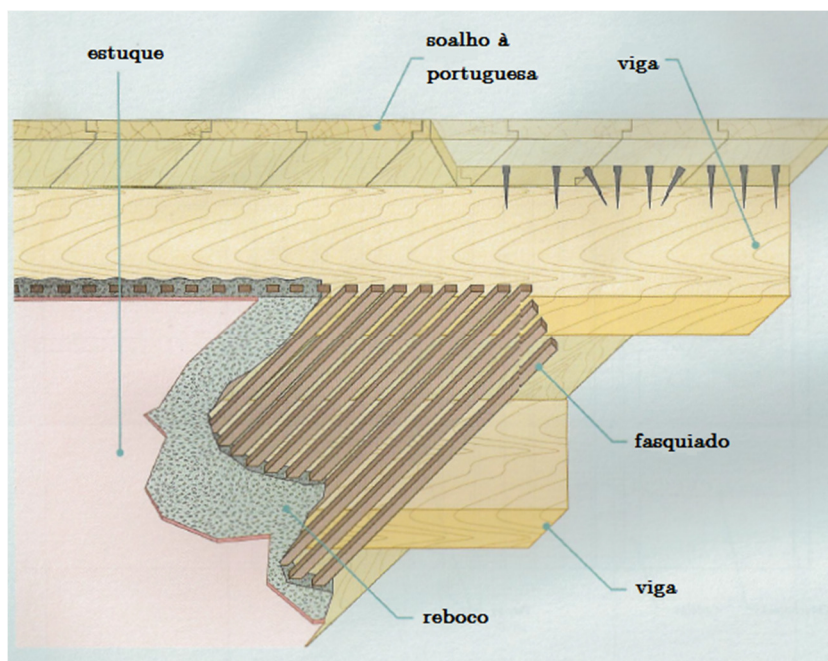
Pavimento de madeira (Appleton, 2003)
